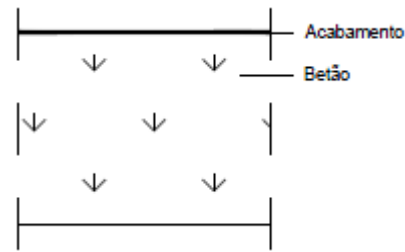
Desenho de pormenor da laje que faz a divisão do piso 0 com o piso 1
